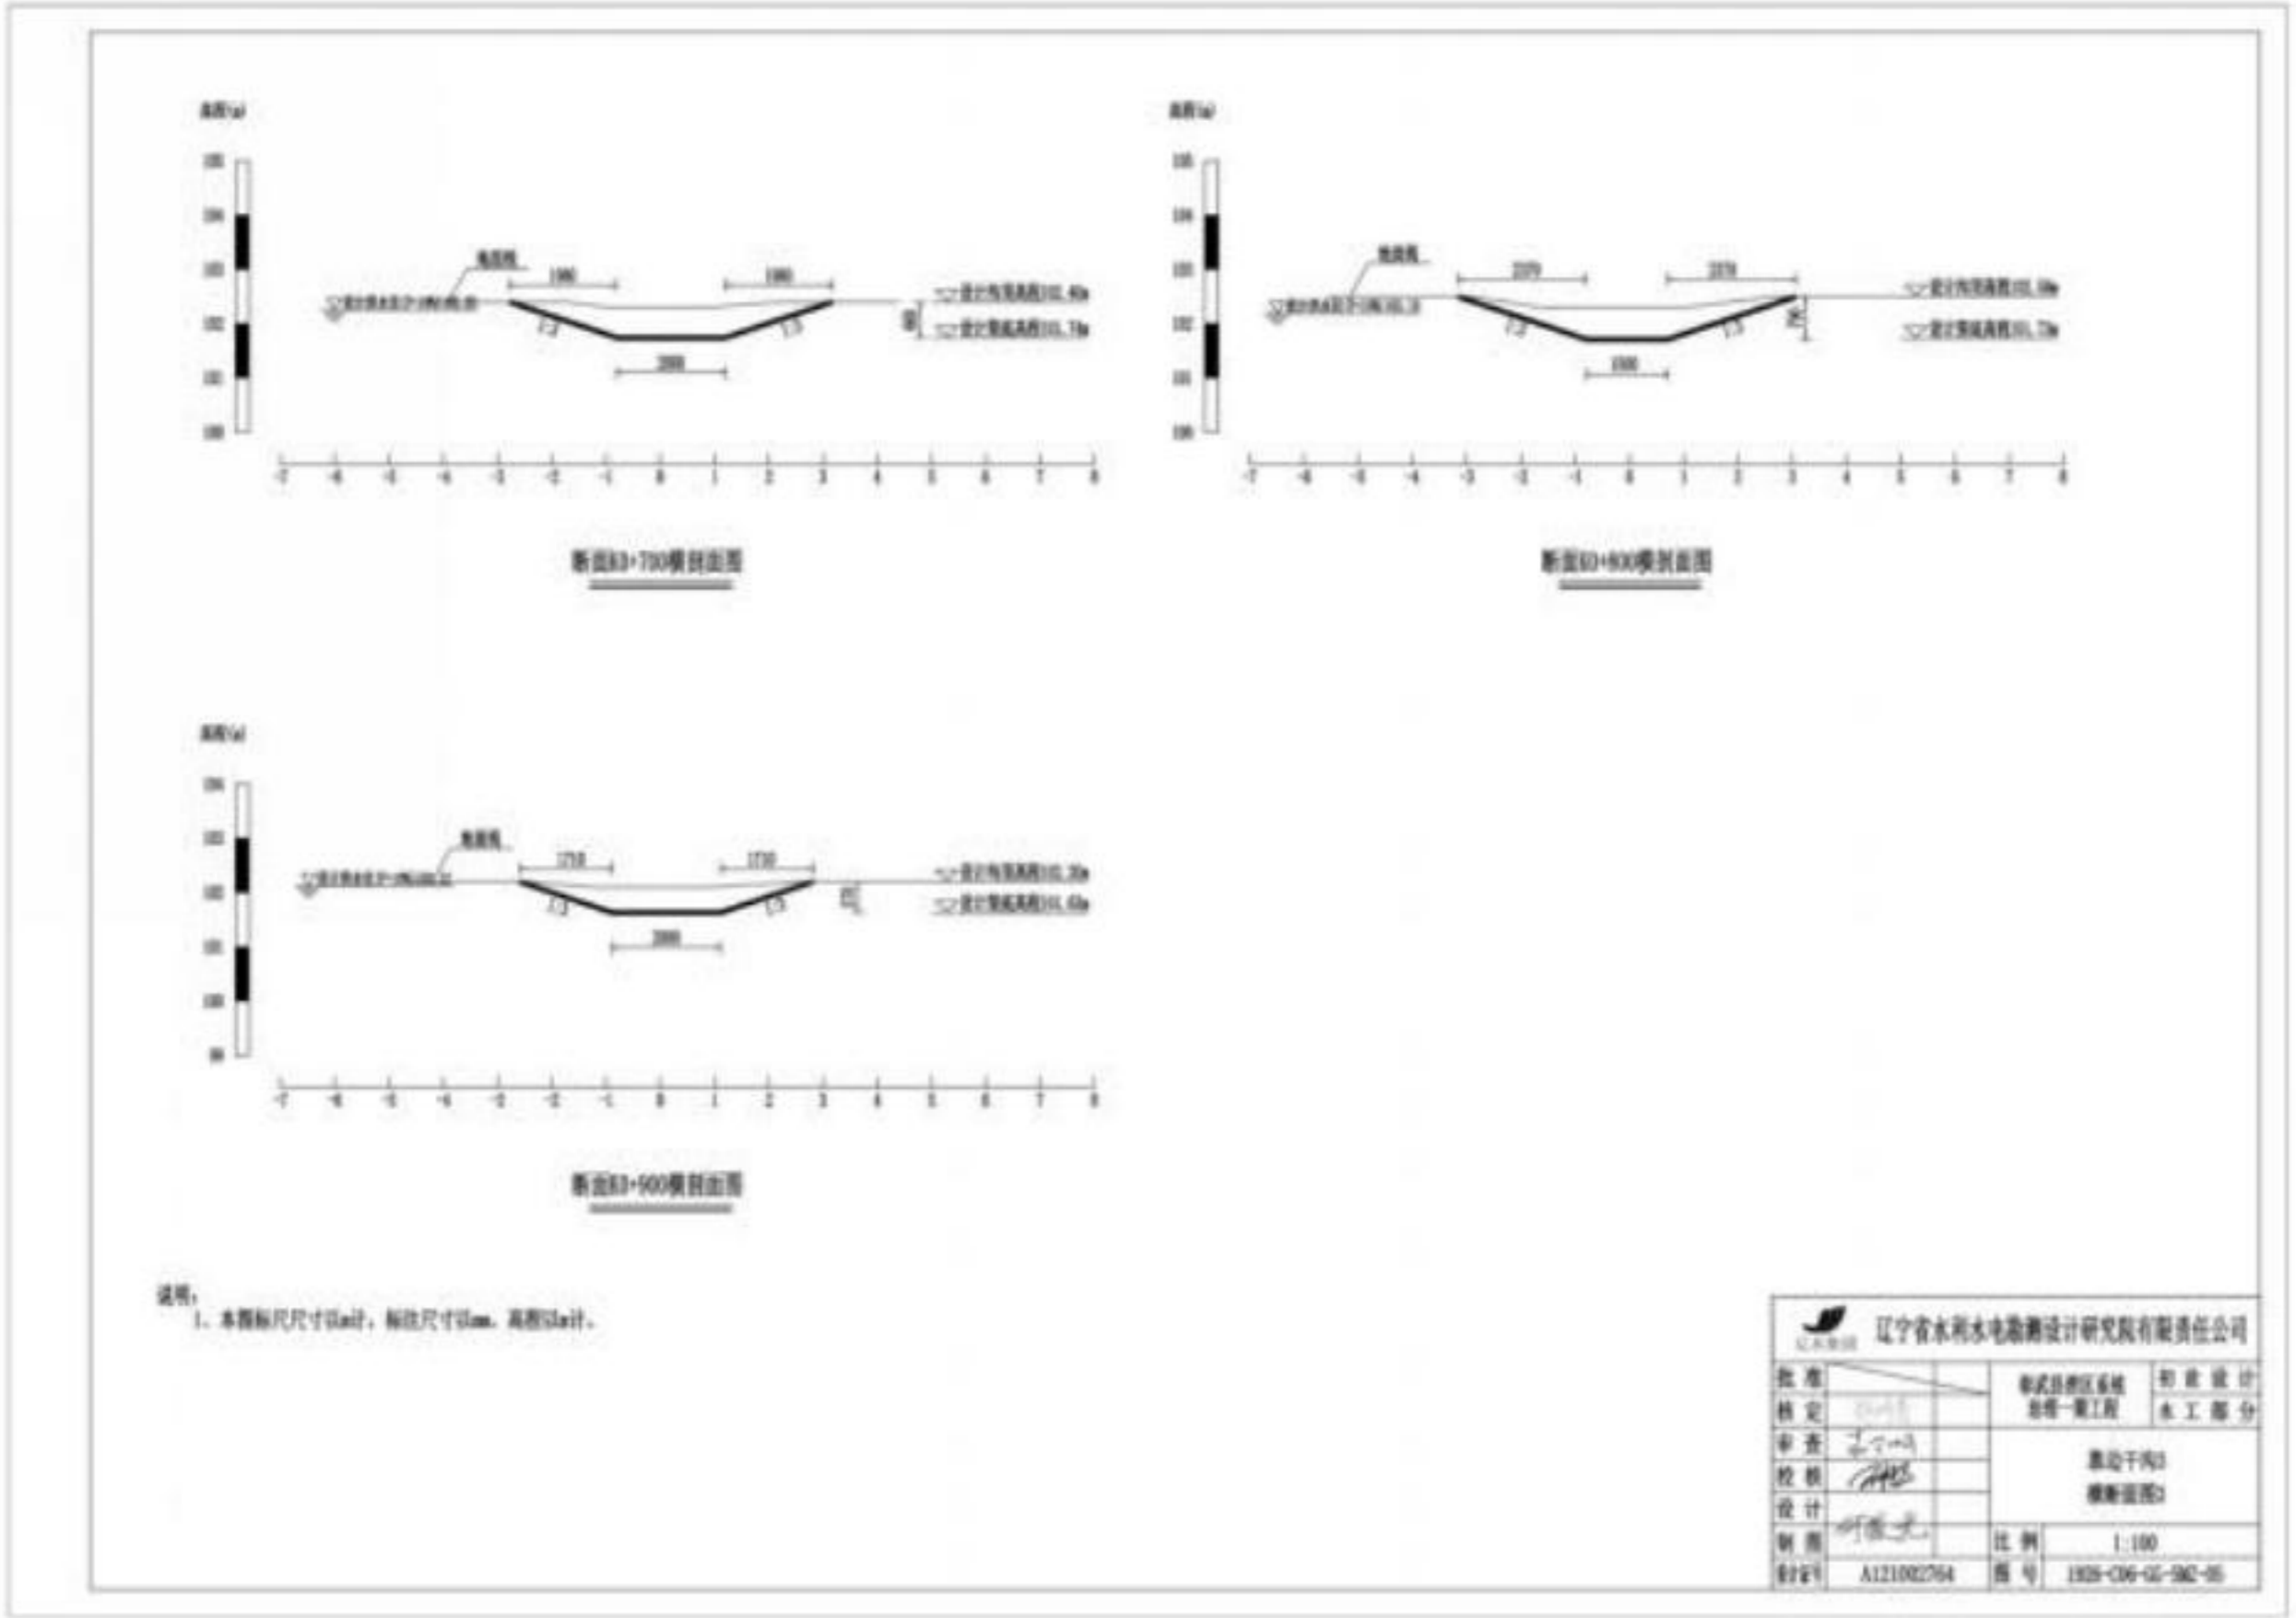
(3) 双庙镇靠边干沟 3 剖面图
